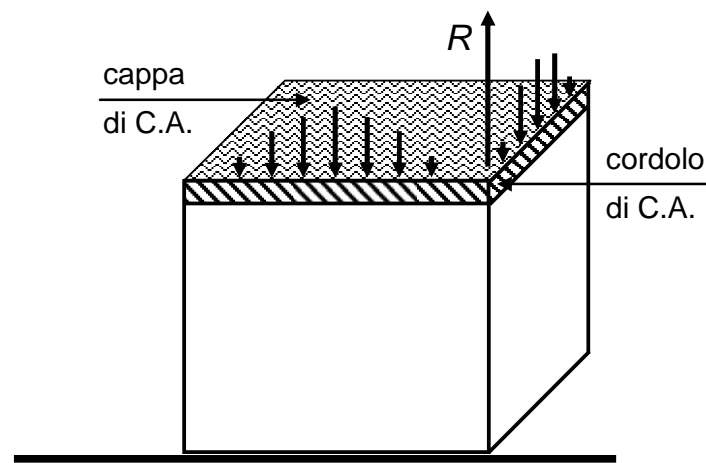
e. Se gli elementi lignei non sono particolarmente rigidi, l'impalcato tende a comportarsi come una piastra a fronte dei carichi ulteriori a quelli di costruzione della cappa stessa. Coerentemente, l'impalcato scarica i sovraccarichi — statici e sismici — come pure i pesi dell'impiantito su tutti e quattro i muri al contorno, anziché solo sui due muri poggia-travetti. Ma soprattutto tale scarico è disuniforme lungo la sommità di ciascun muro, con massimo al centro del muro e nullo agli spigoli. Agli spigoli, inoltre, lo scarico bi-direzionale comporta una forza concentrata verticale, R , diretta verso l'alto. Tale forza R può sorpassare il 35 % della reazione totale verso il basso distribuita sul muro d'appoggio.
